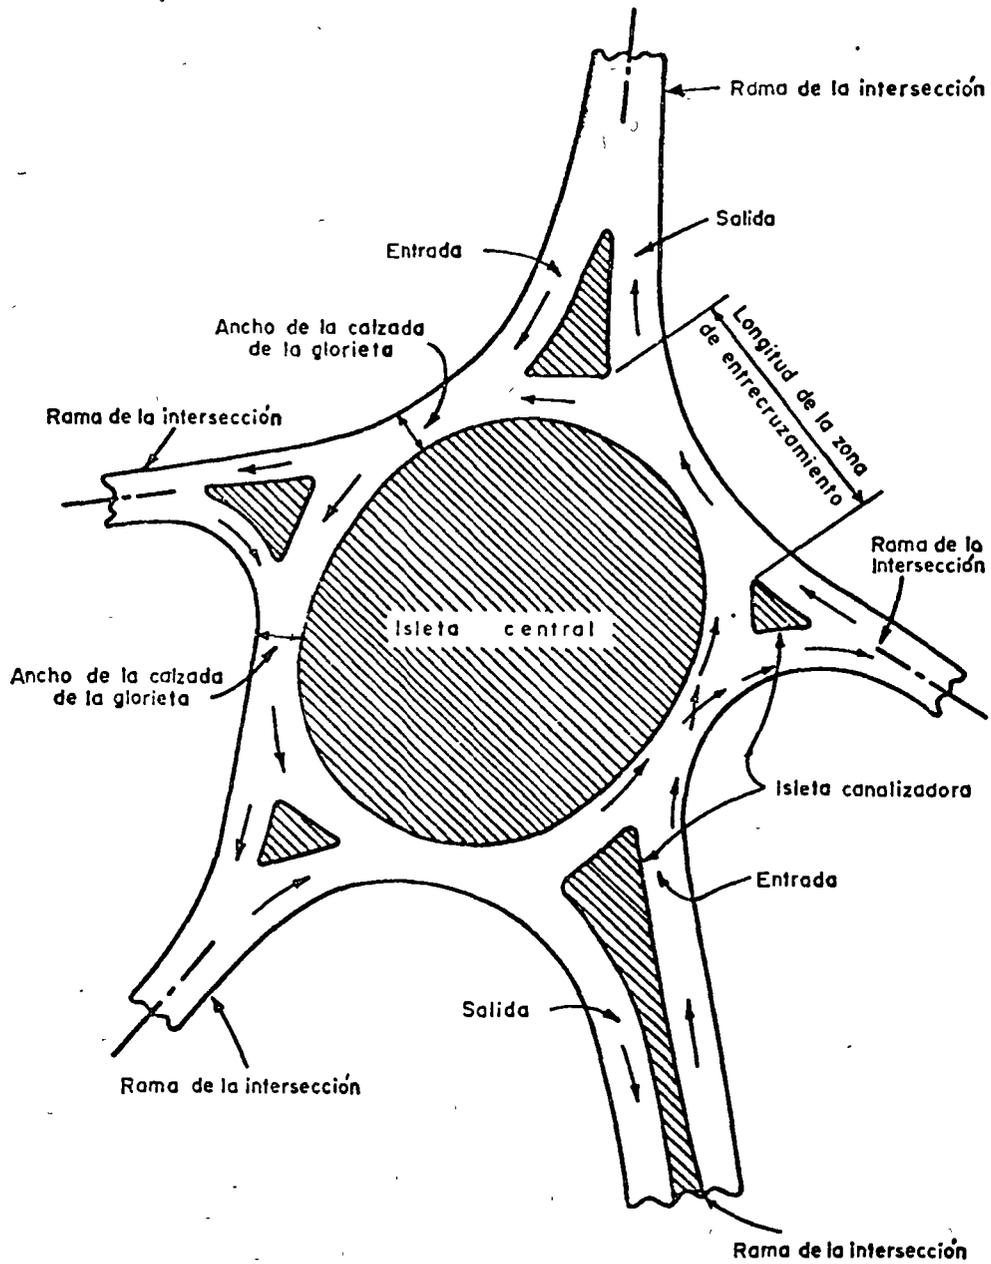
79. TERMINOS EMPLEADOS EN EL PROYECTO DE GLORIETAS
